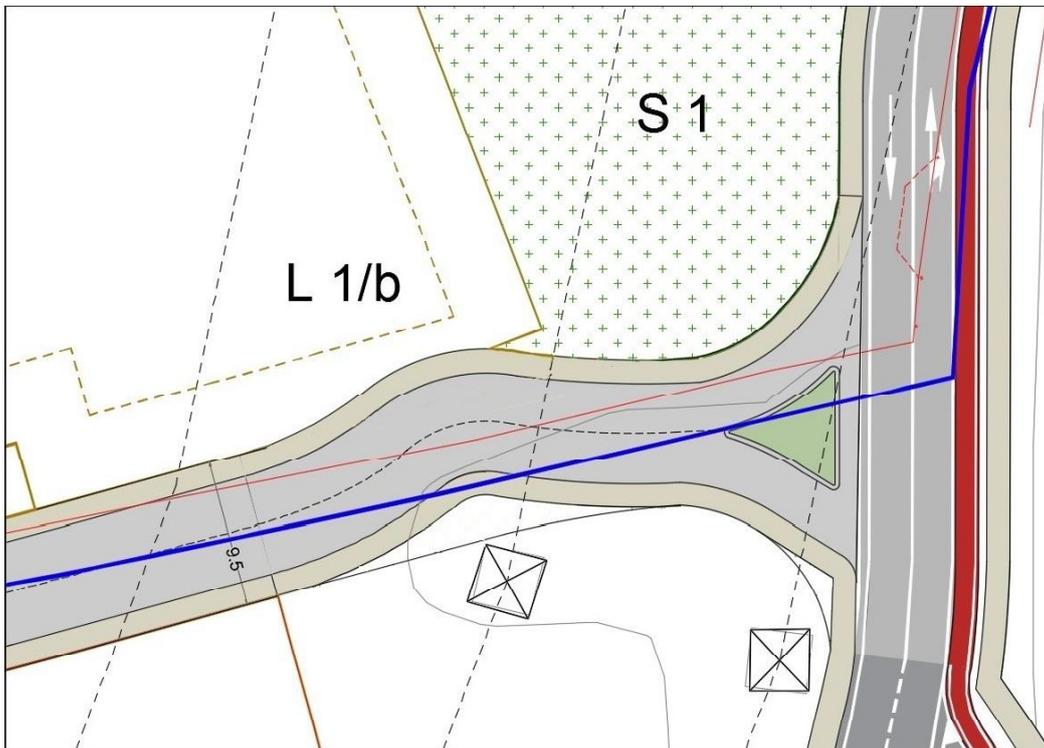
Strada D - Stralcio elaborato Planovolumetrico di variante.
